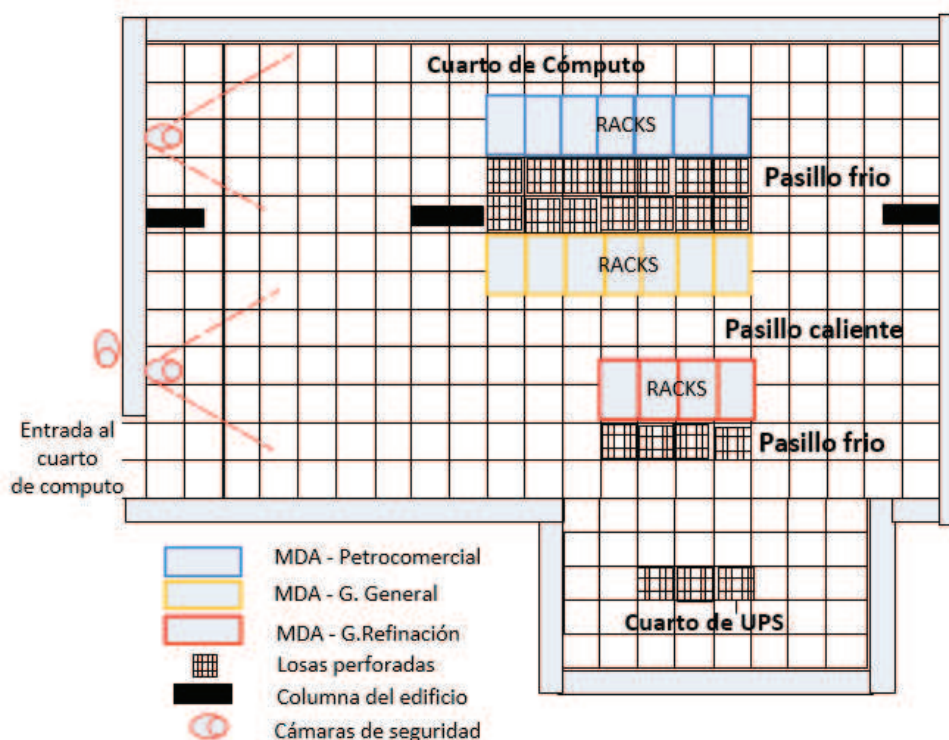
Ubicación de las losas en el piso falso y cámaras de seguridad.
